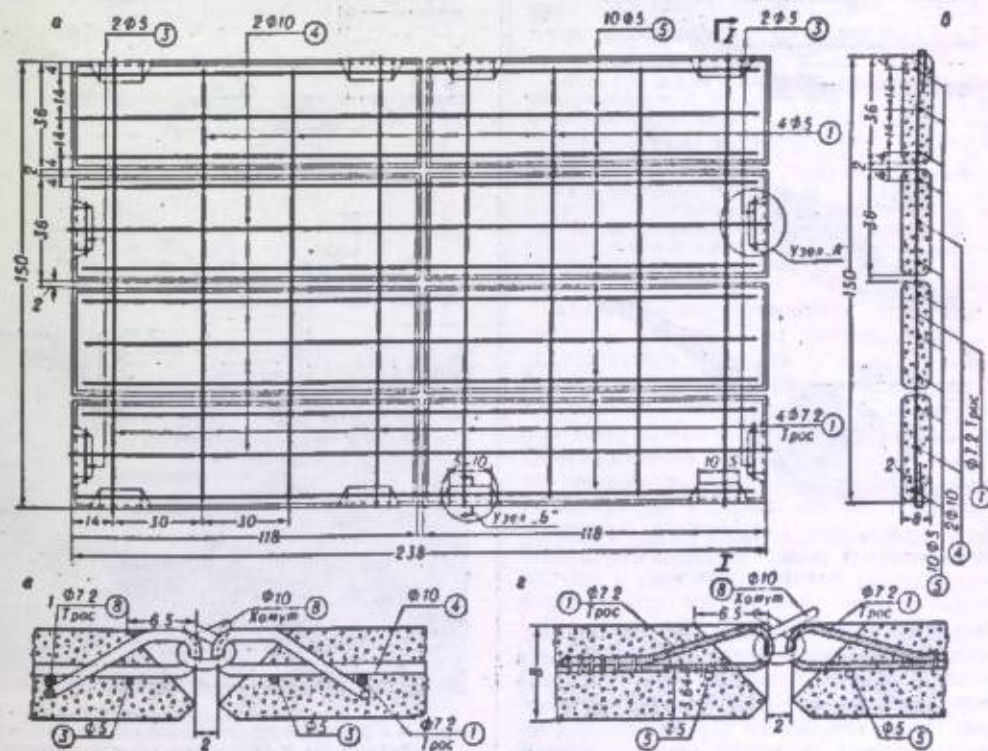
Тюфяк из железобетонных плит: а — план; б — разрез I-I; в — соединение тюфяков в узлах «А»; г — в узлах «Б».
